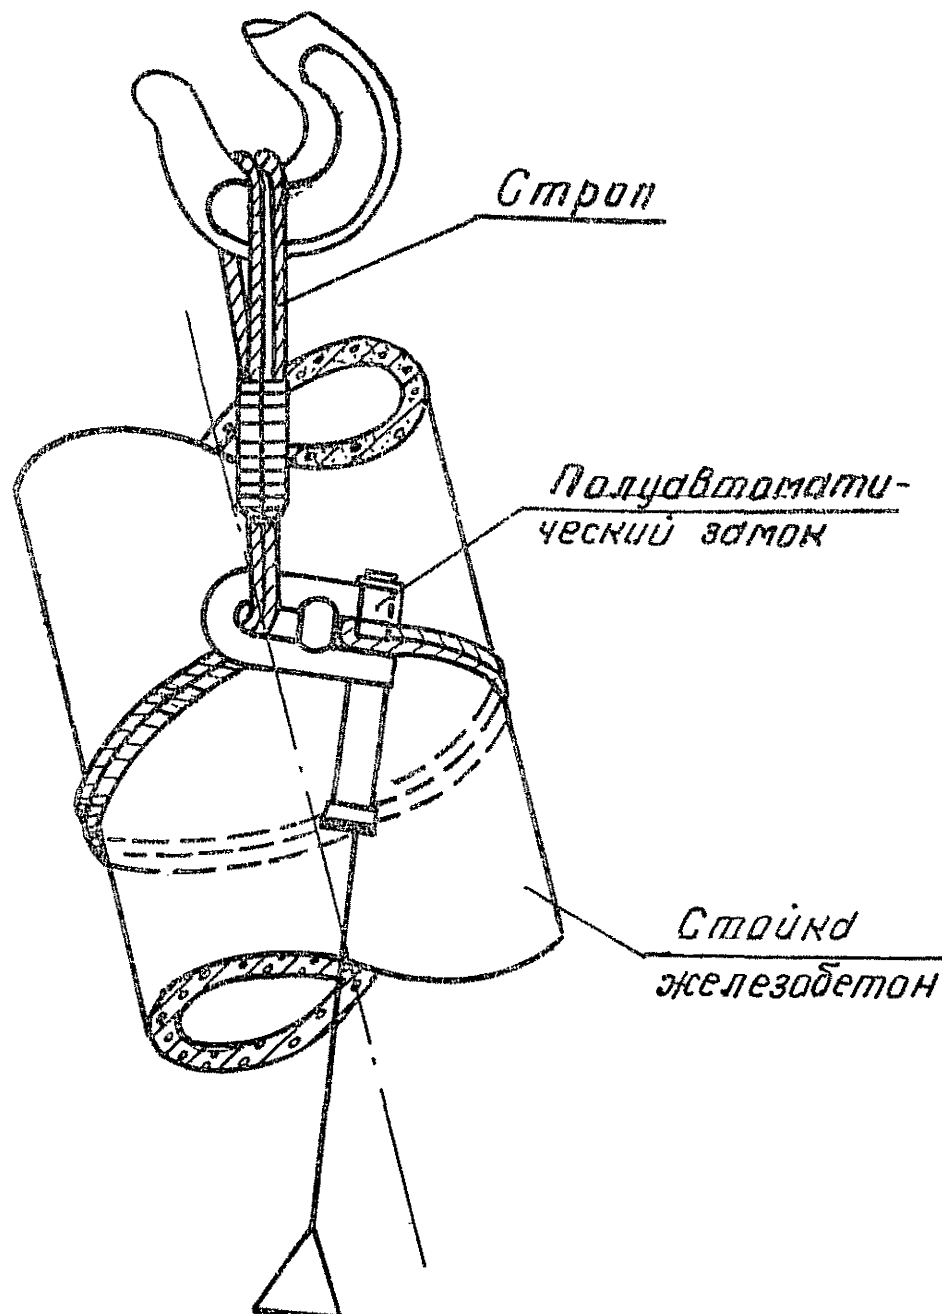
Схема строповки железобетонной стойки полуавтоматическим стропом с захватом Смаля (Узел А).
